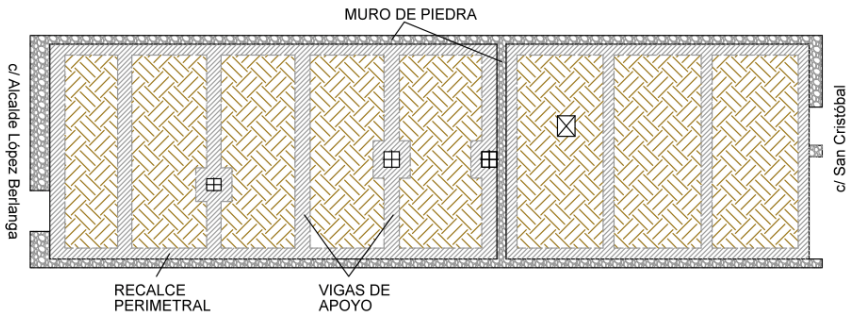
Distribución del recalce perimetral y las vigas de apoyo. Fuente propia.
